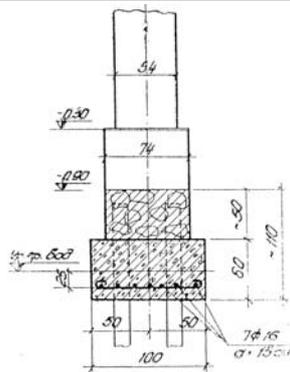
Усиление фундаментов здания по 4-й Советской ул., 38 [3]
